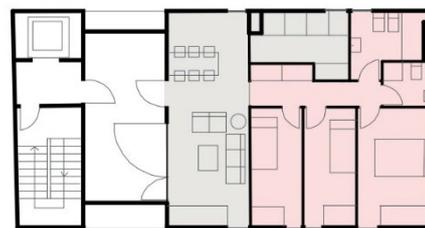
Esquema circulación planta tipo. Elaboración propia
